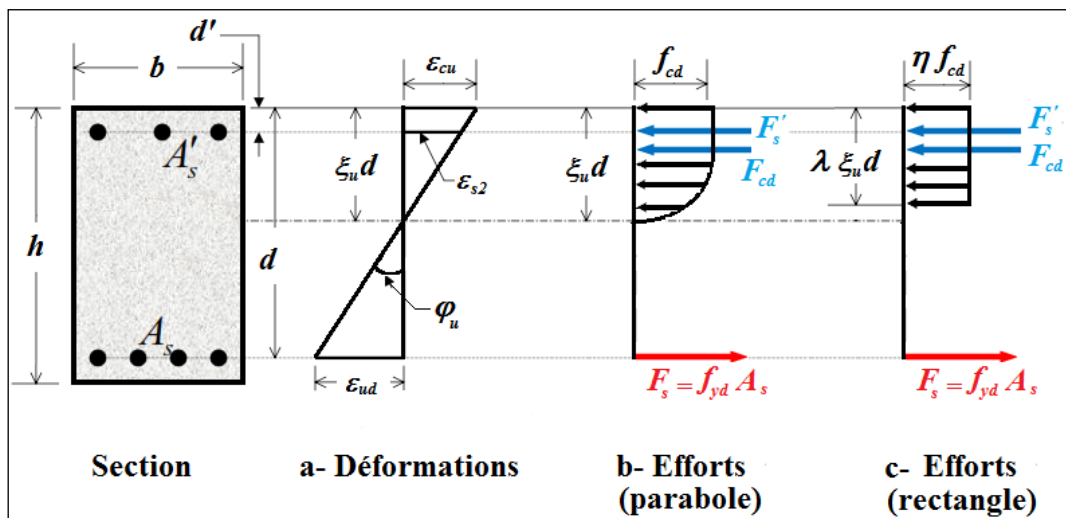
Comportement de la section d'une poutre fléchie en béton armé à l'état limite ultime.
